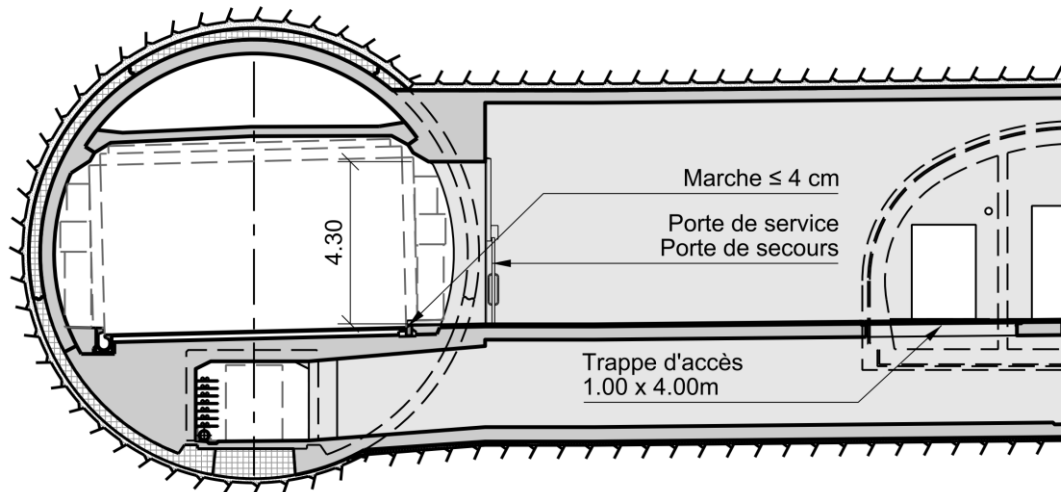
Coupe longitudinale avec trappe d'accès à la galerie technique
